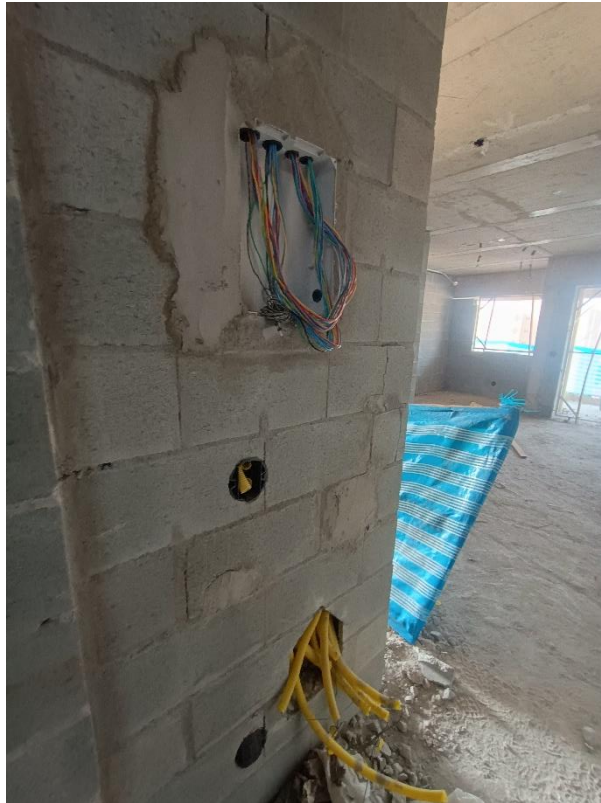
9º pavimento– visão geral caixinha ponto elétrico e caixa de distribuição unidade privativa;
